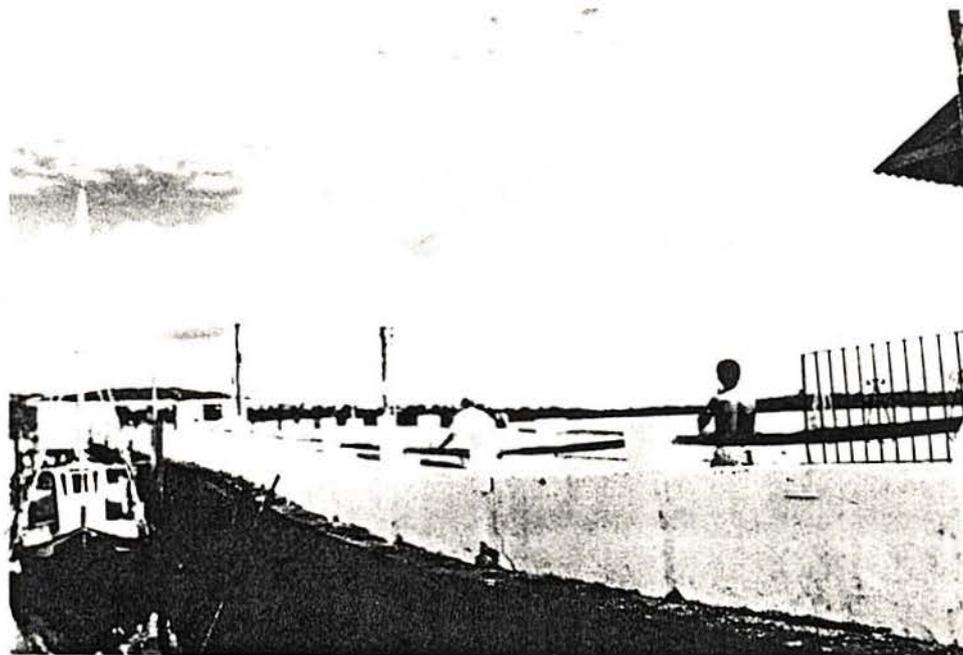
Aspecto da laje de um trapiche apresentando deformação excessiva
